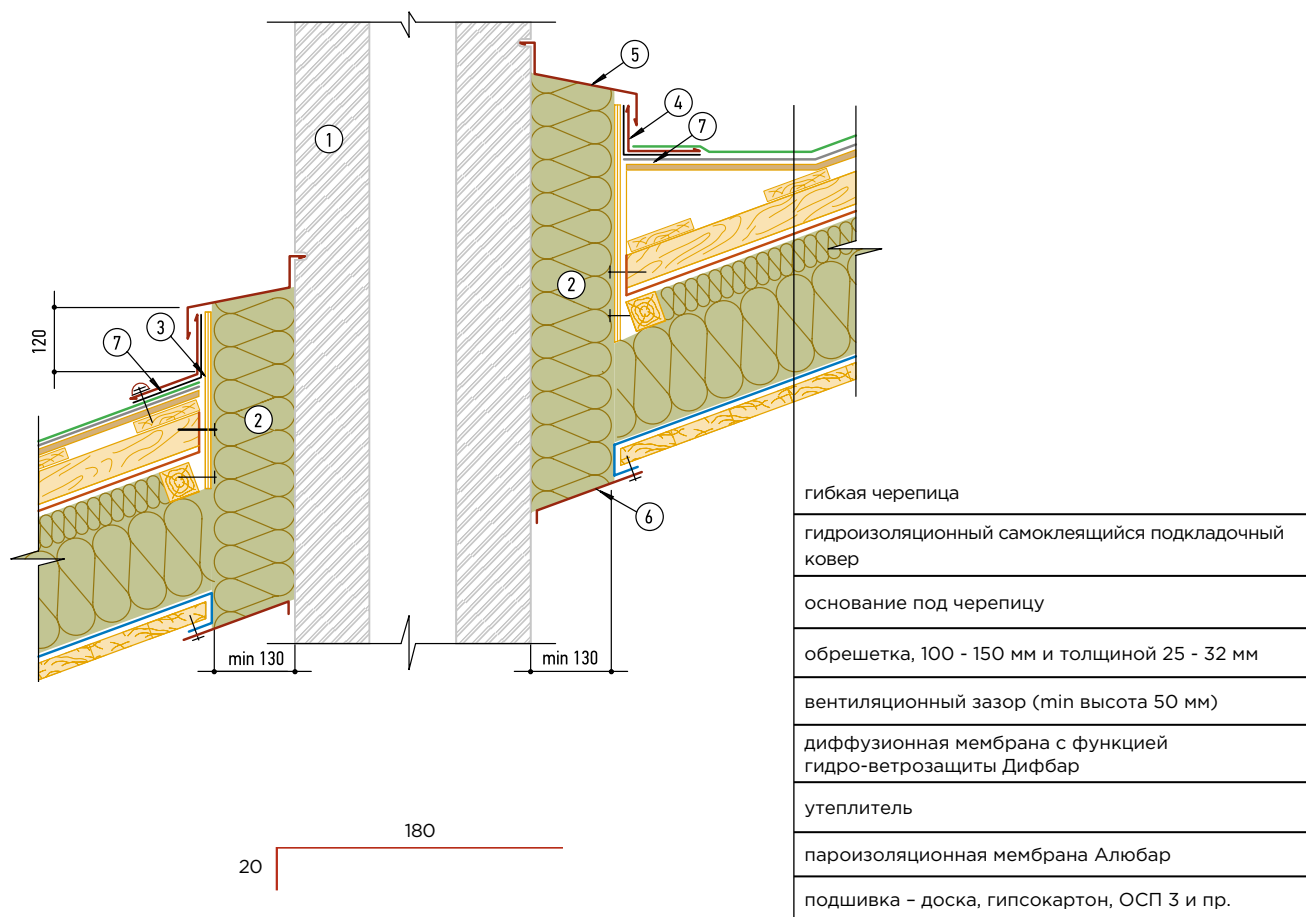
Вариант примыкания кровли мансарды к дымовой трубе
